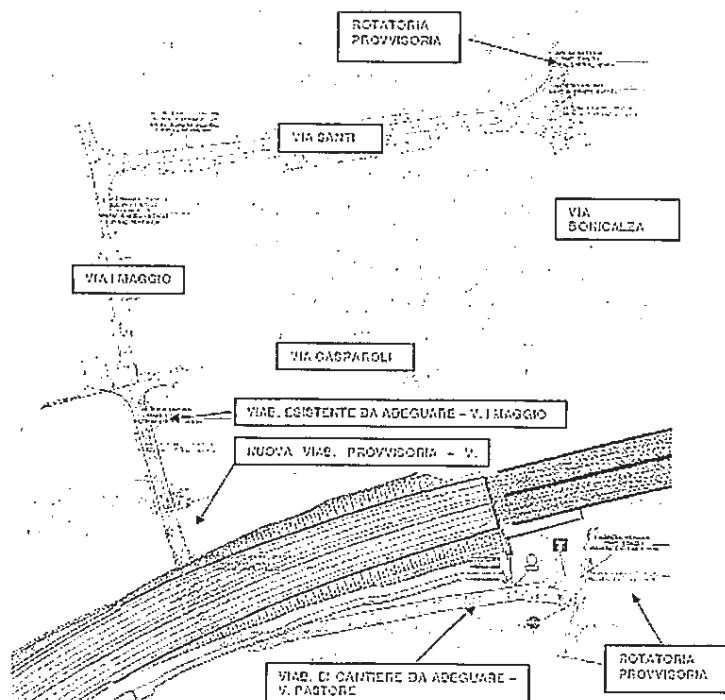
Planimetria viabilità provvisoria Via Bonicalza – SP 20
